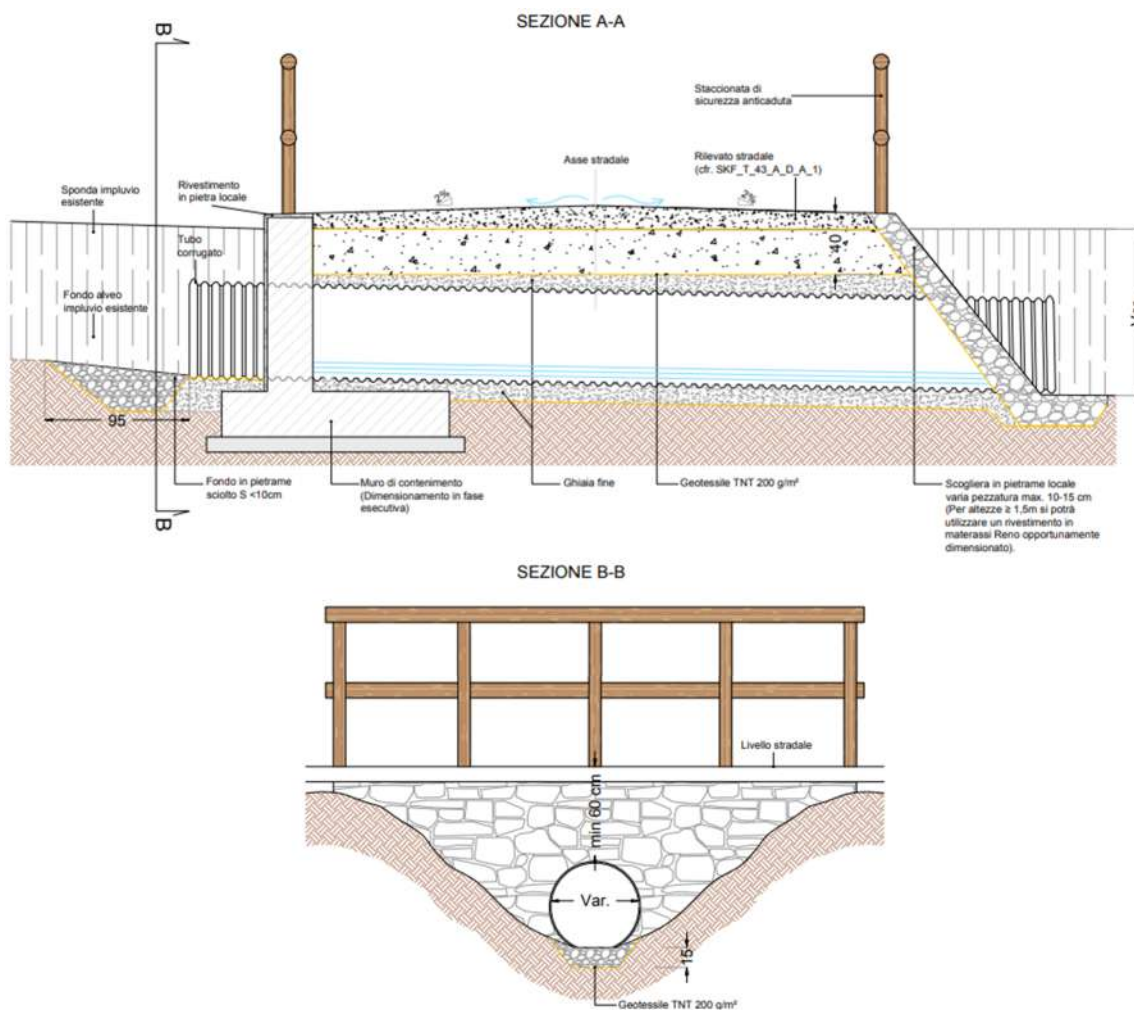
Opera di attraversamento idraulico, sezione trasversale e vista frontale lato monte (misure in cm)
